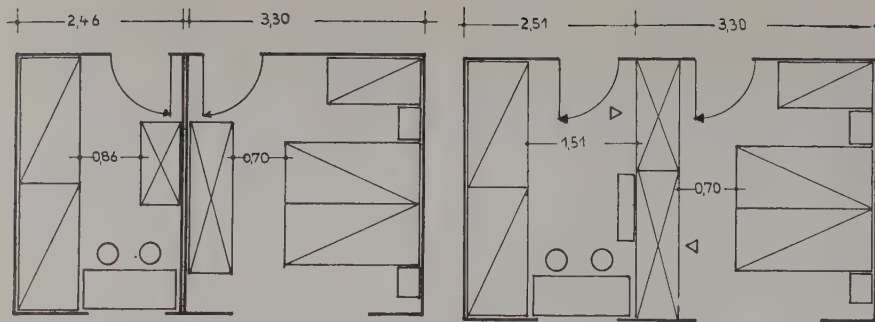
Zimmer ohne Schrankeinbau — 1:100
